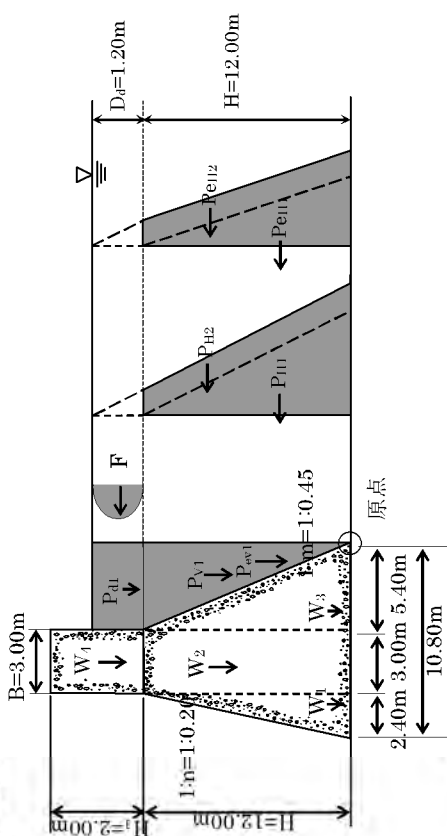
砂防堰堤に作用する力 (断面 (3) : 土石流時)
